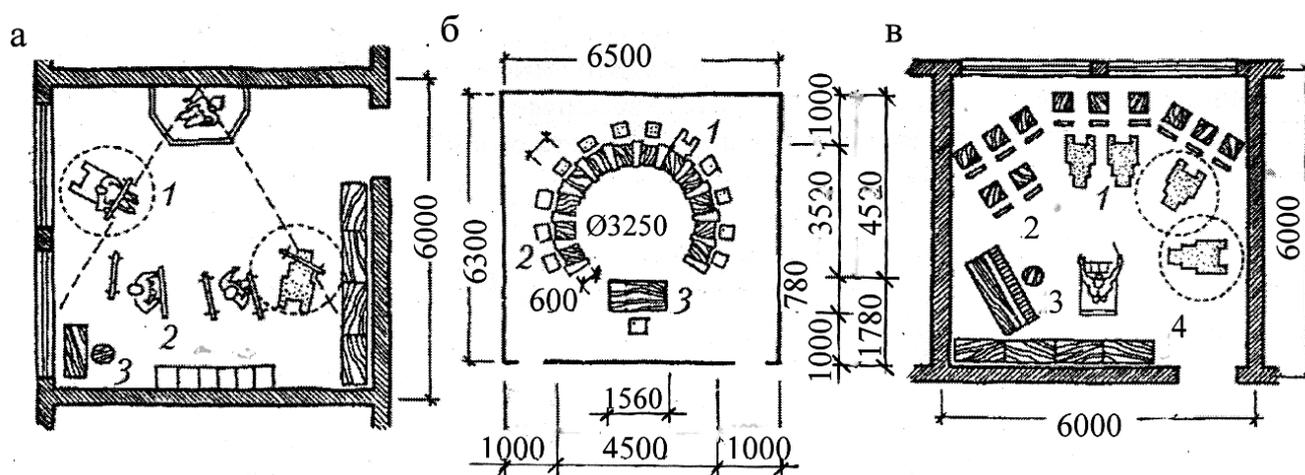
Примеры помещений для кружковой работы: а – студия живописи; б – универсальное помещение; в - музыкальный класс; 1 – место для инвалида; 2 – обычные кружковые места; 3 – место преподавателя; 4 – полки для нот
